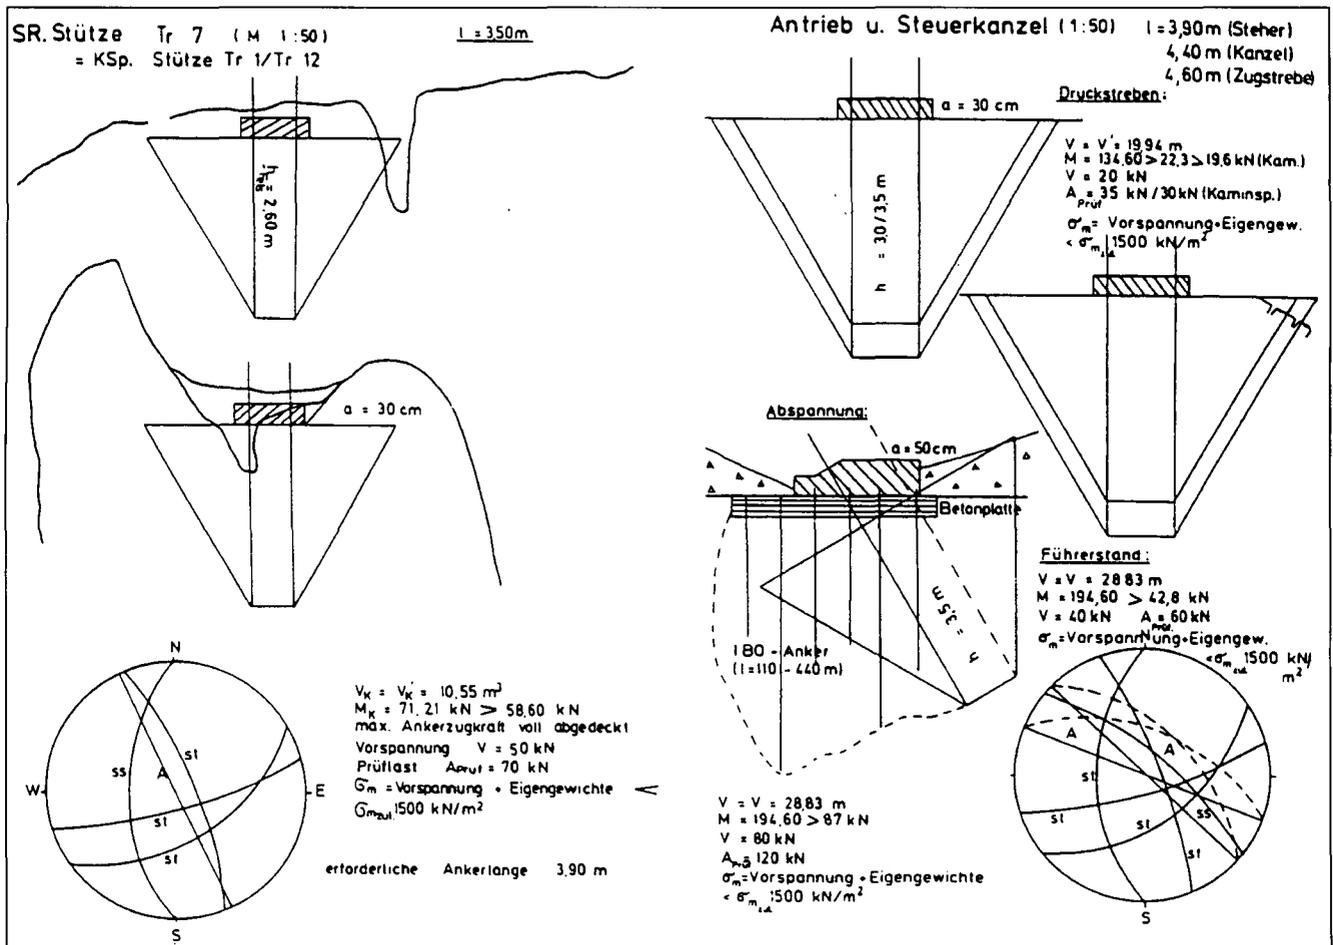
Lawinensprengseilbahn Kaminspitzen (Nordkette Innsbruck): Konstruktions- und Bemessungspläne der Fundamente von Antriebsstation (Injektionspfahl-Ortbetonplatte) und einer Seilbahnstütze (verankertes Ausgleichsfundament).
